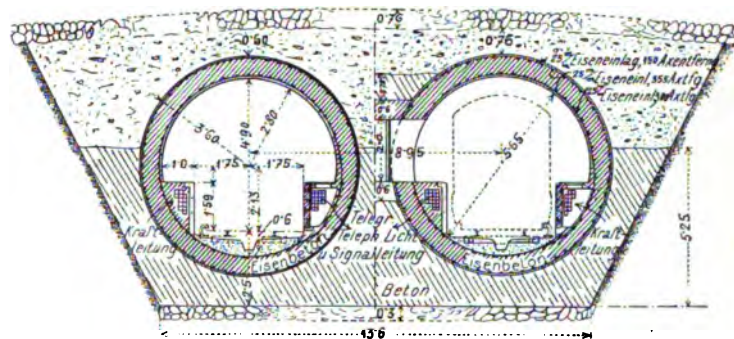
Querschnitt des Entwurfs B für den Detroit-Tunnel.
